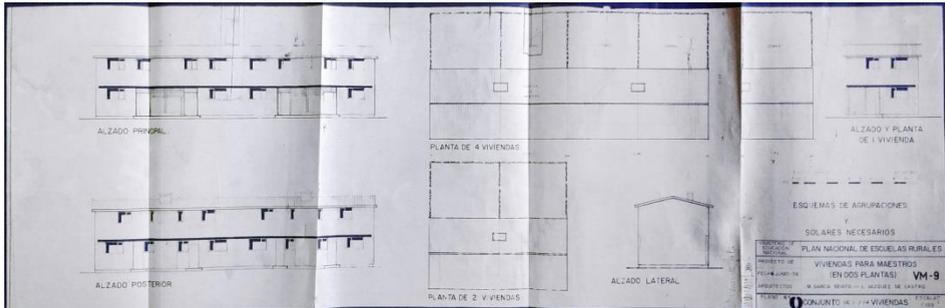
Proyecto-tipo VM-9. Alzados y plantas generales.
